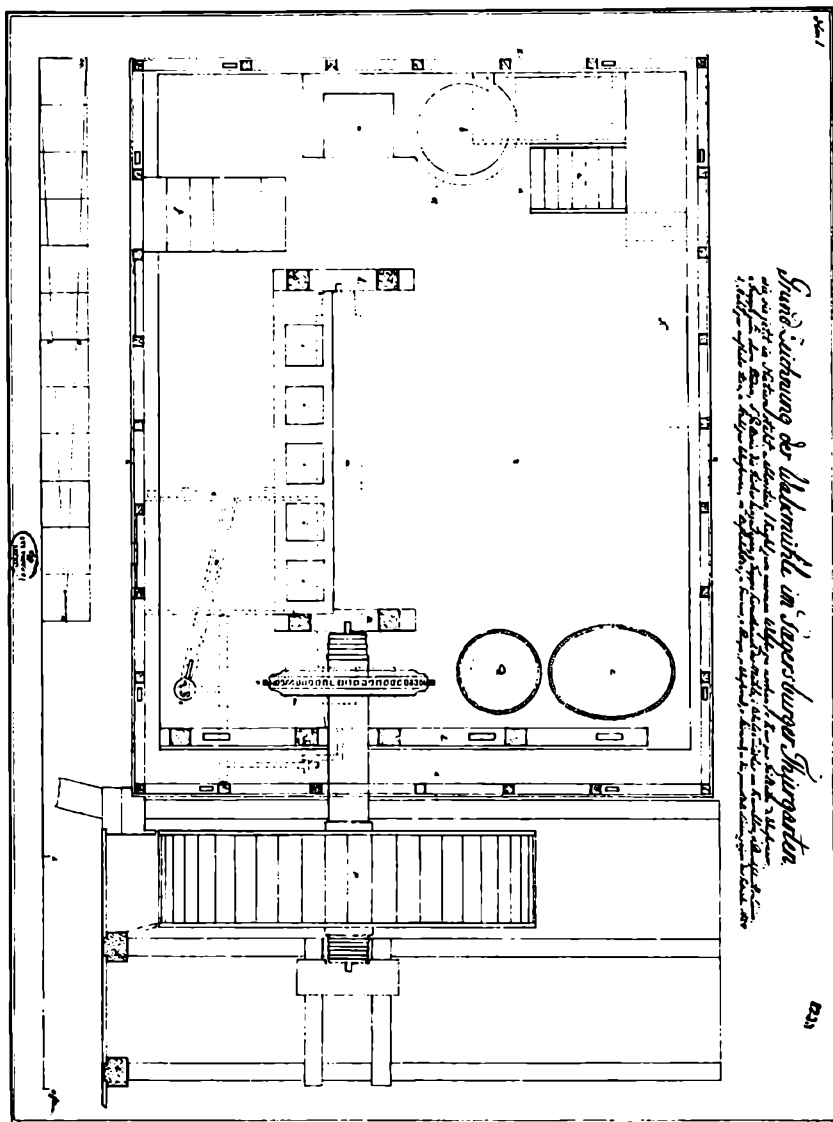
Nationalmuseets Billedarkiv: Anno 1824: DK-568-Stampen, konstruktions-tegning: plan, maal 1/100.
